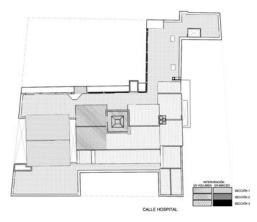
Plano de la planta cubierta, con indicación de las diferentes intervenciones (Jordi Salvat)
